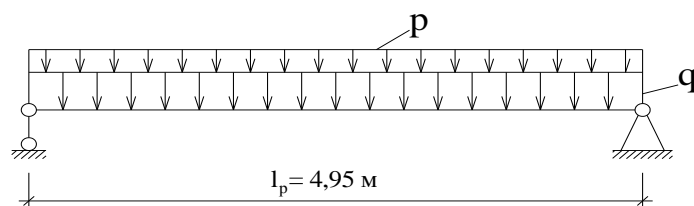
Нагрузки, действующие на плиту перекрытия:
